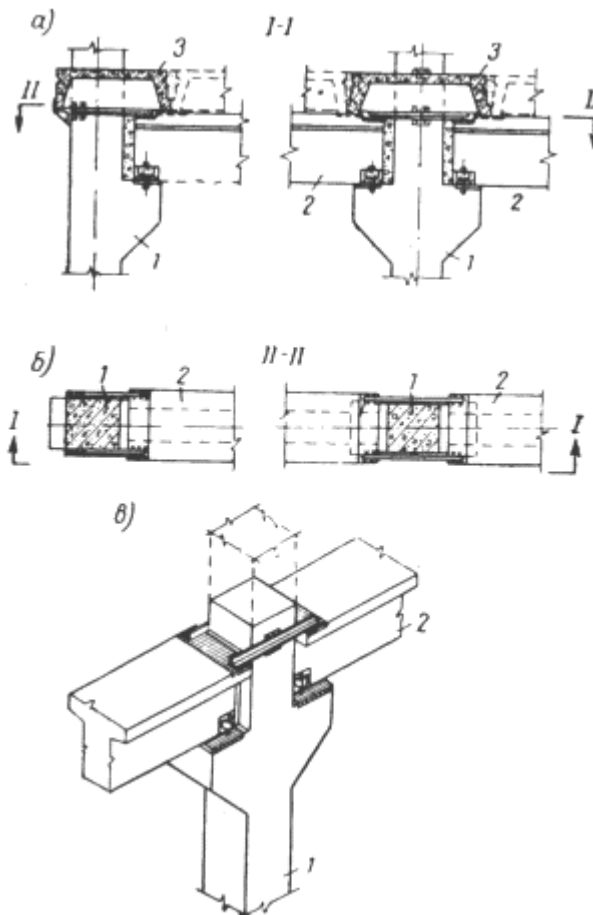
Сопряжение элементов каркаса. а — ригелей и настилов; б, в — ригелей с колоннами; 1 — колонна; 2 — ригель; 3 — настил.
